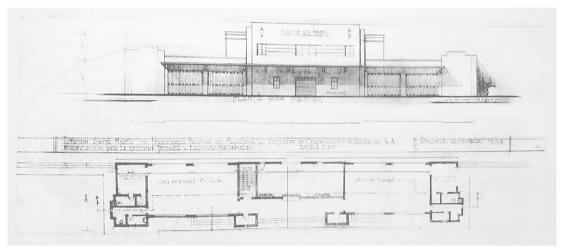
Planta primer piso y fachada interior de la estación de Santa Marta del Ferrocarril del Magdalena, 1934
